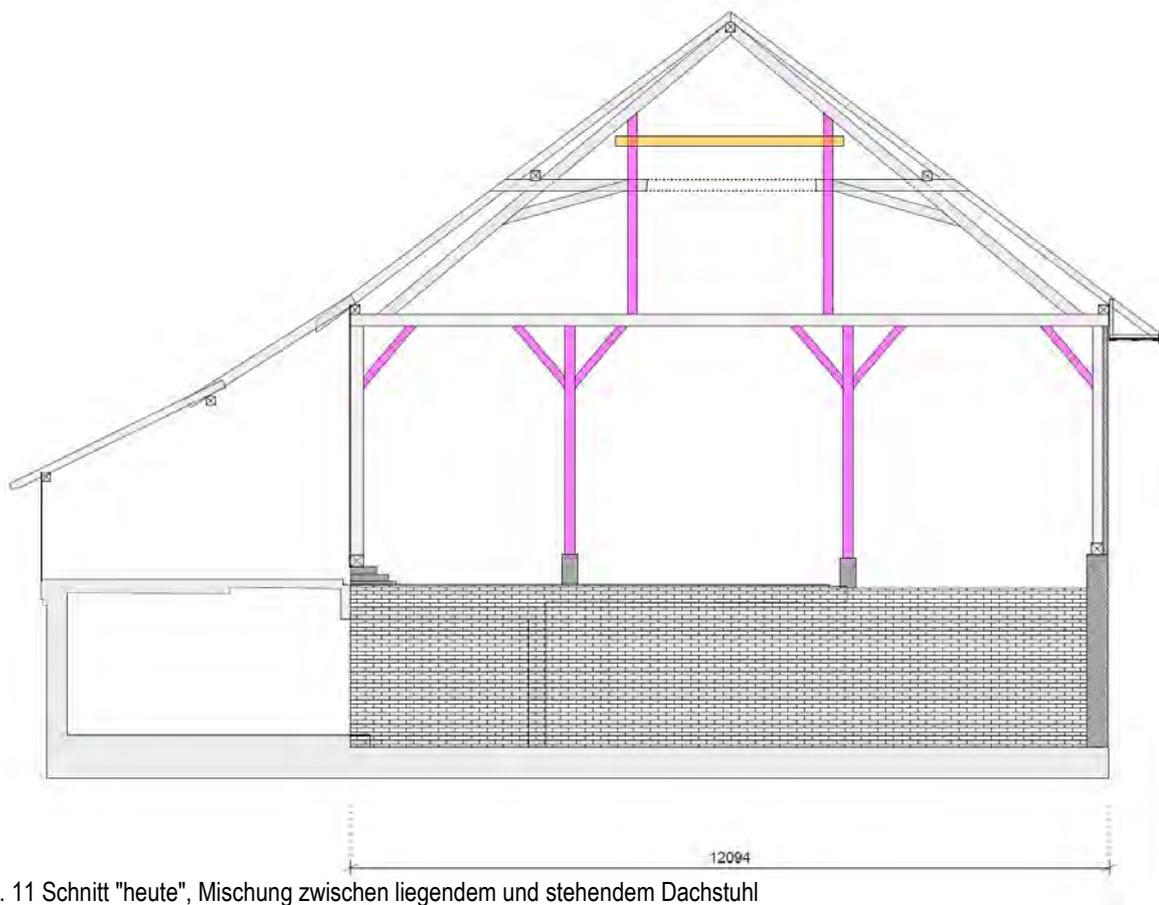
Schnitt "heute", Mischung zwischen liegendem und stehendem Dachstuhl
